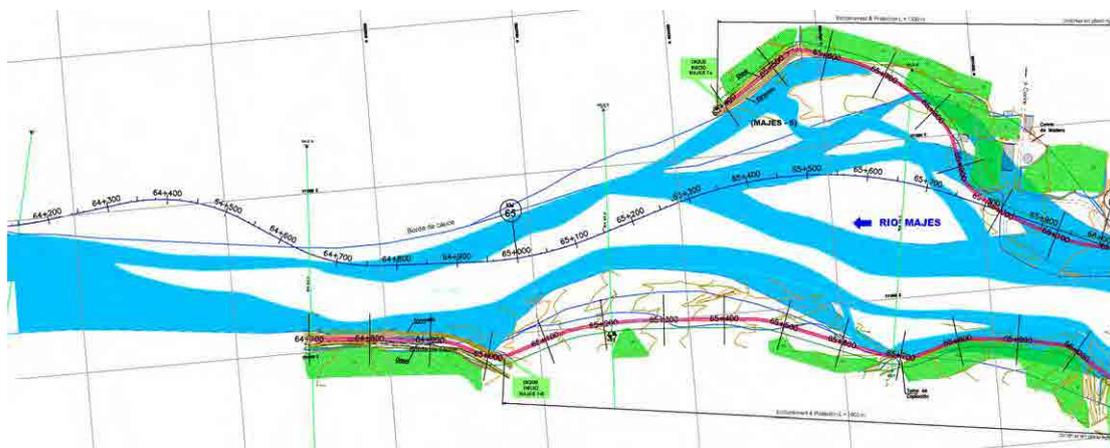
Planta de instalaciones Majes-7 (2)
